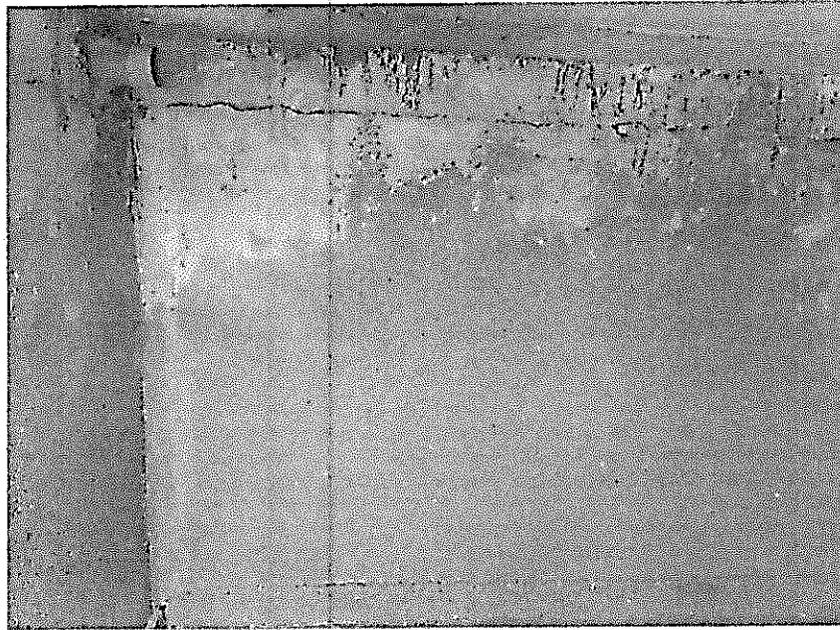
Fisura en todo el perímetro del tanque a 1.70 metros de altura desde la base. "fuente propia".
